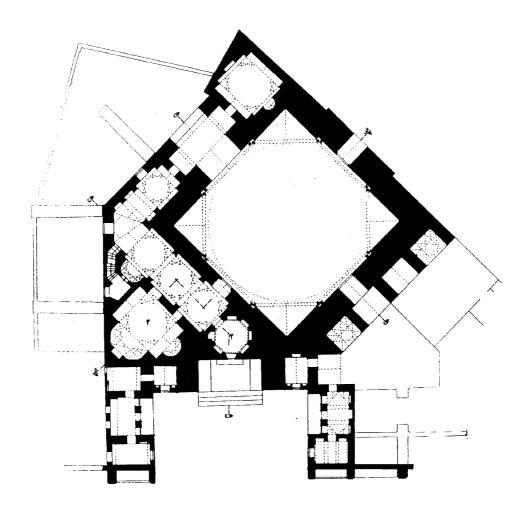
مسقط أفقي لمسجد Hadun في ياكوفكا (عن : Pašić).
